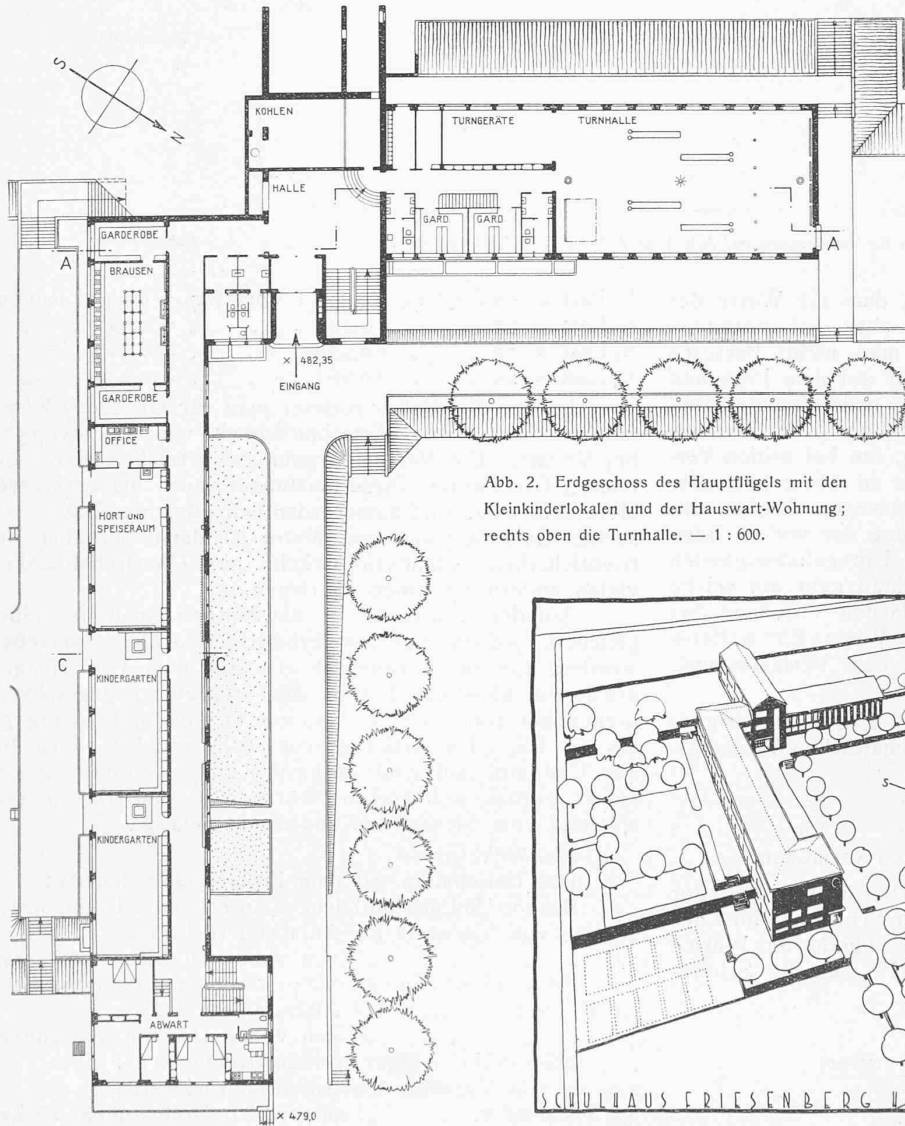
Erdgeschoss des Hauptflügels mit den Kleinkinderlokalen und der Hauswart-Wohnung; rechts oben die Turnhalle. — 1 : 600.
